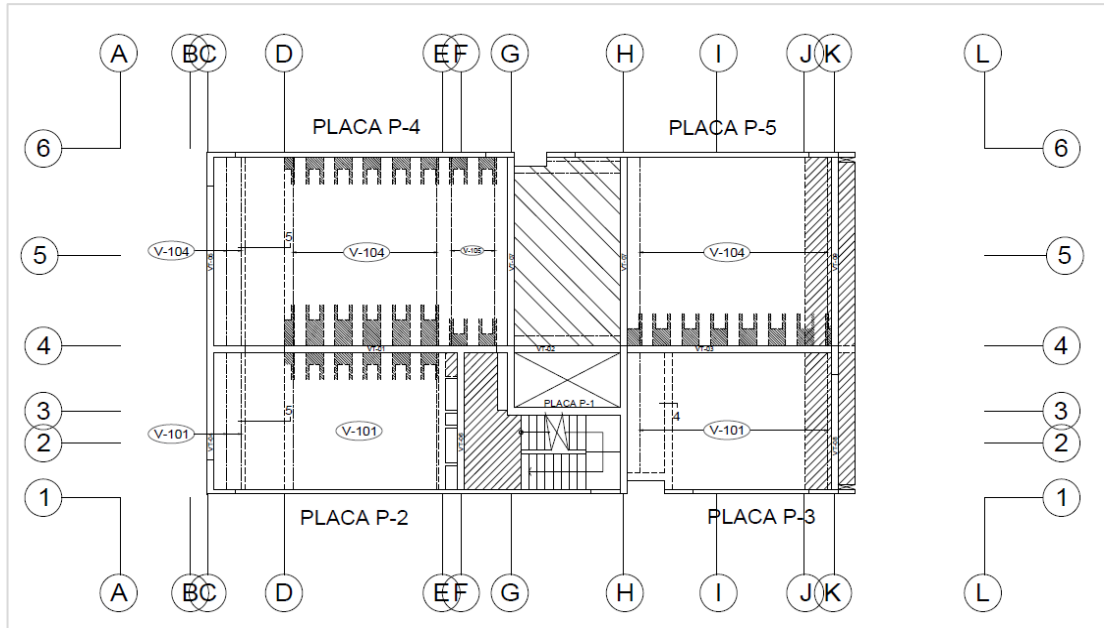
Vista en planta de elementos estructurales de pisos típicos
